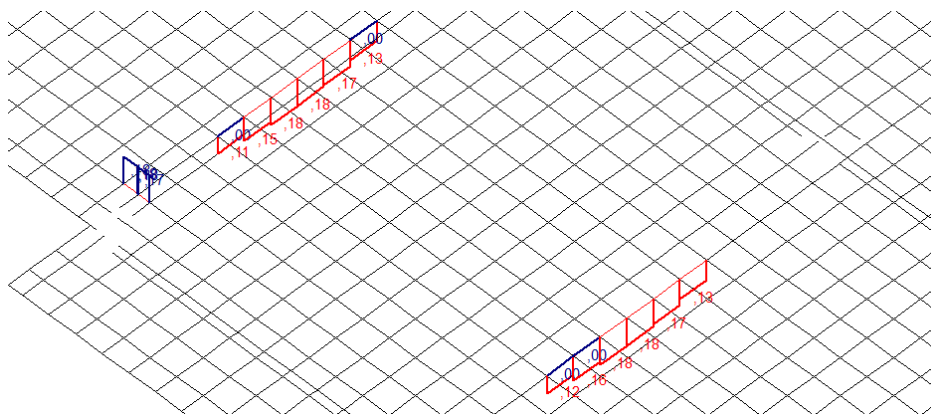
Ampliação da abertura de fissuras no pavimento PT1 da Solução Convencional com abertura máxima de 0,18 mm
